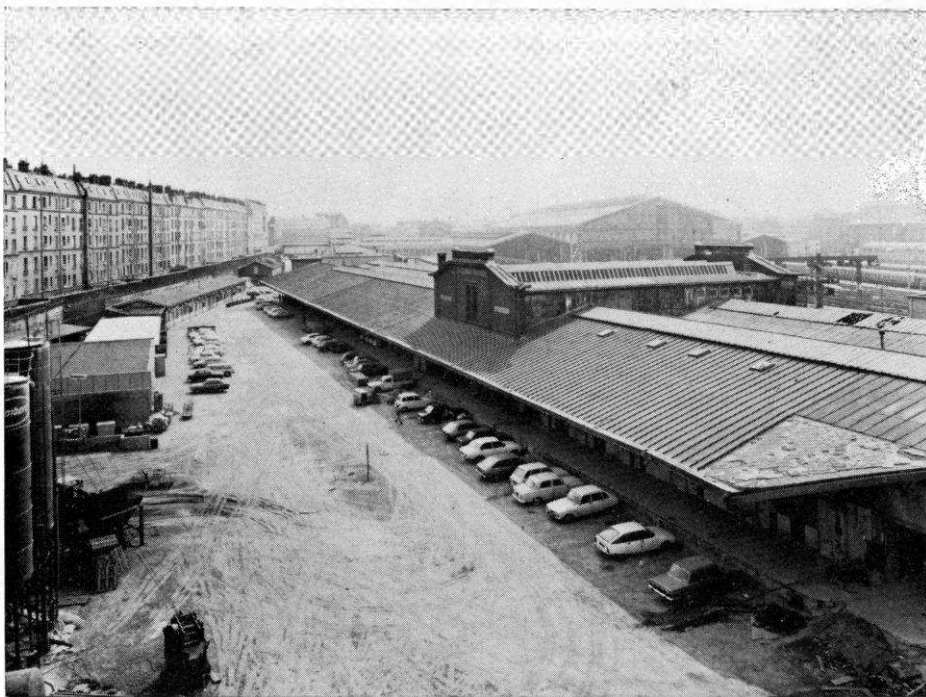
Vue prise en direction du Sud de la Cour des Messageries où doit se construire la gare souterraine. A droite : les halles qui doivent disparaître. A gauche : premières installations de chantier. (Photo Billerach).
